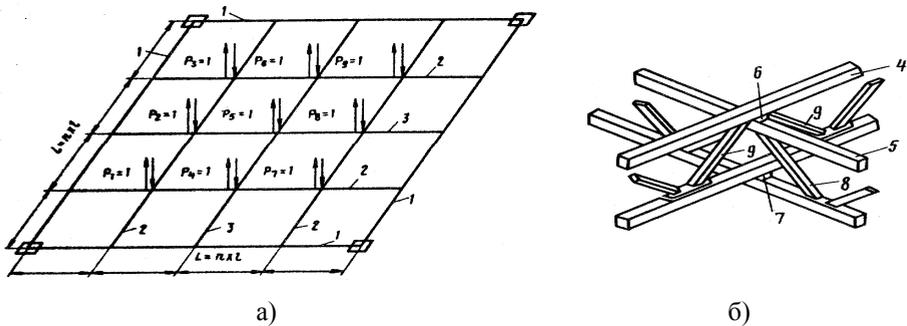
Расчетная схема (а) и аксонометрия узла пересечения ферм (б) покрытия:
